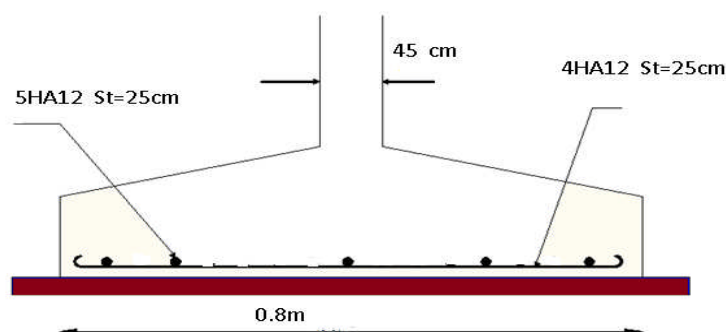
Schéma de ferrailage de la semelle de potelet.
